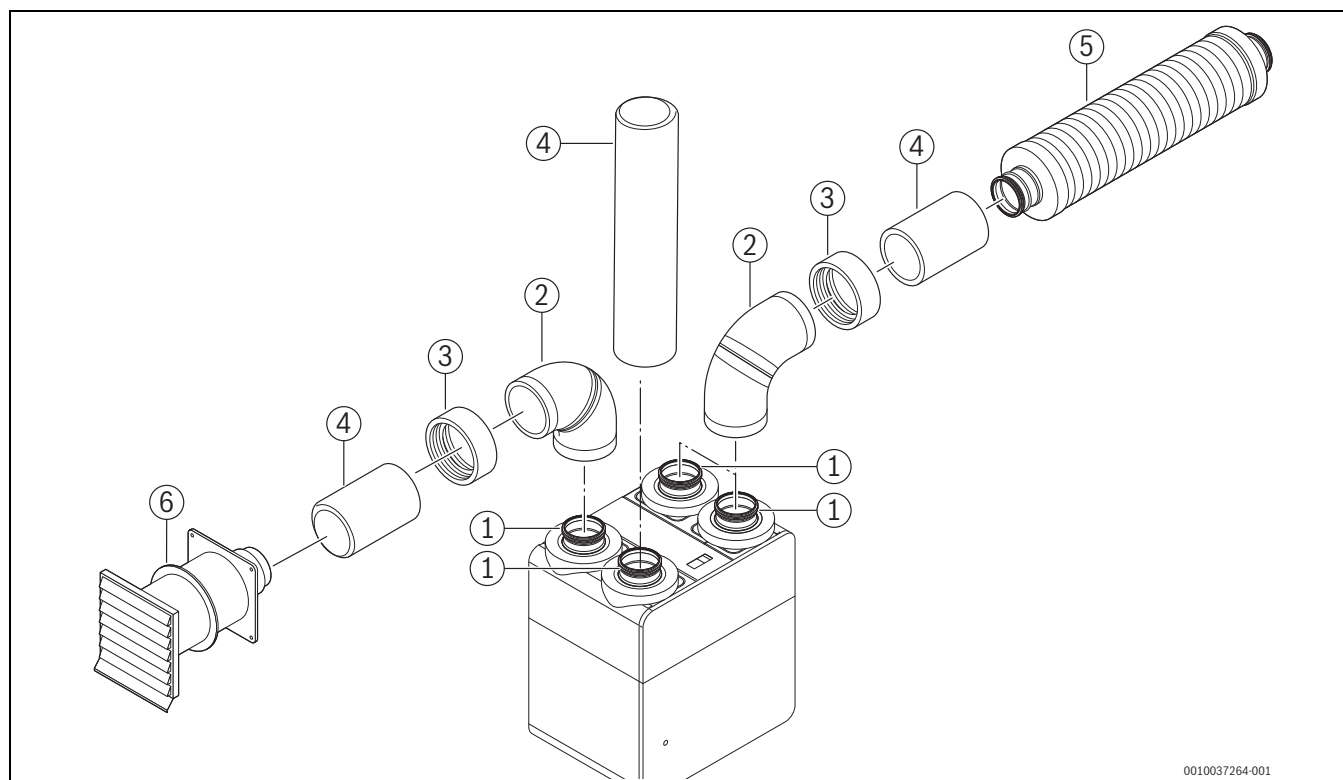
Wariant 1: pionowe przyłącza urządzenia - prowadzenie powietrza wariant B
